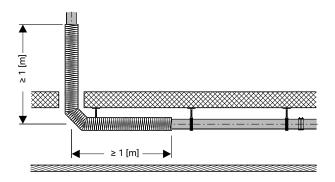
Luftschalldämmung im Bereich einer Fallleitungsverziehung oder beim Übergang einer Fallleitung in eine Sammelleitung
